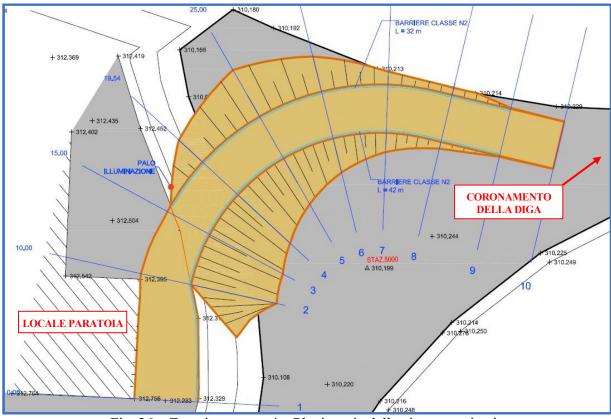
Zona intervento 4 – Planimetria della pista provvisoria
